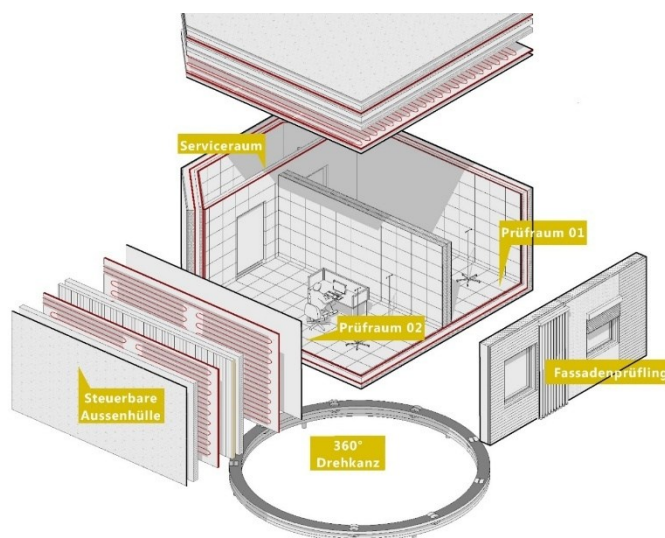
Aufbau der AEE INTEC Fassadenprüfbox.
